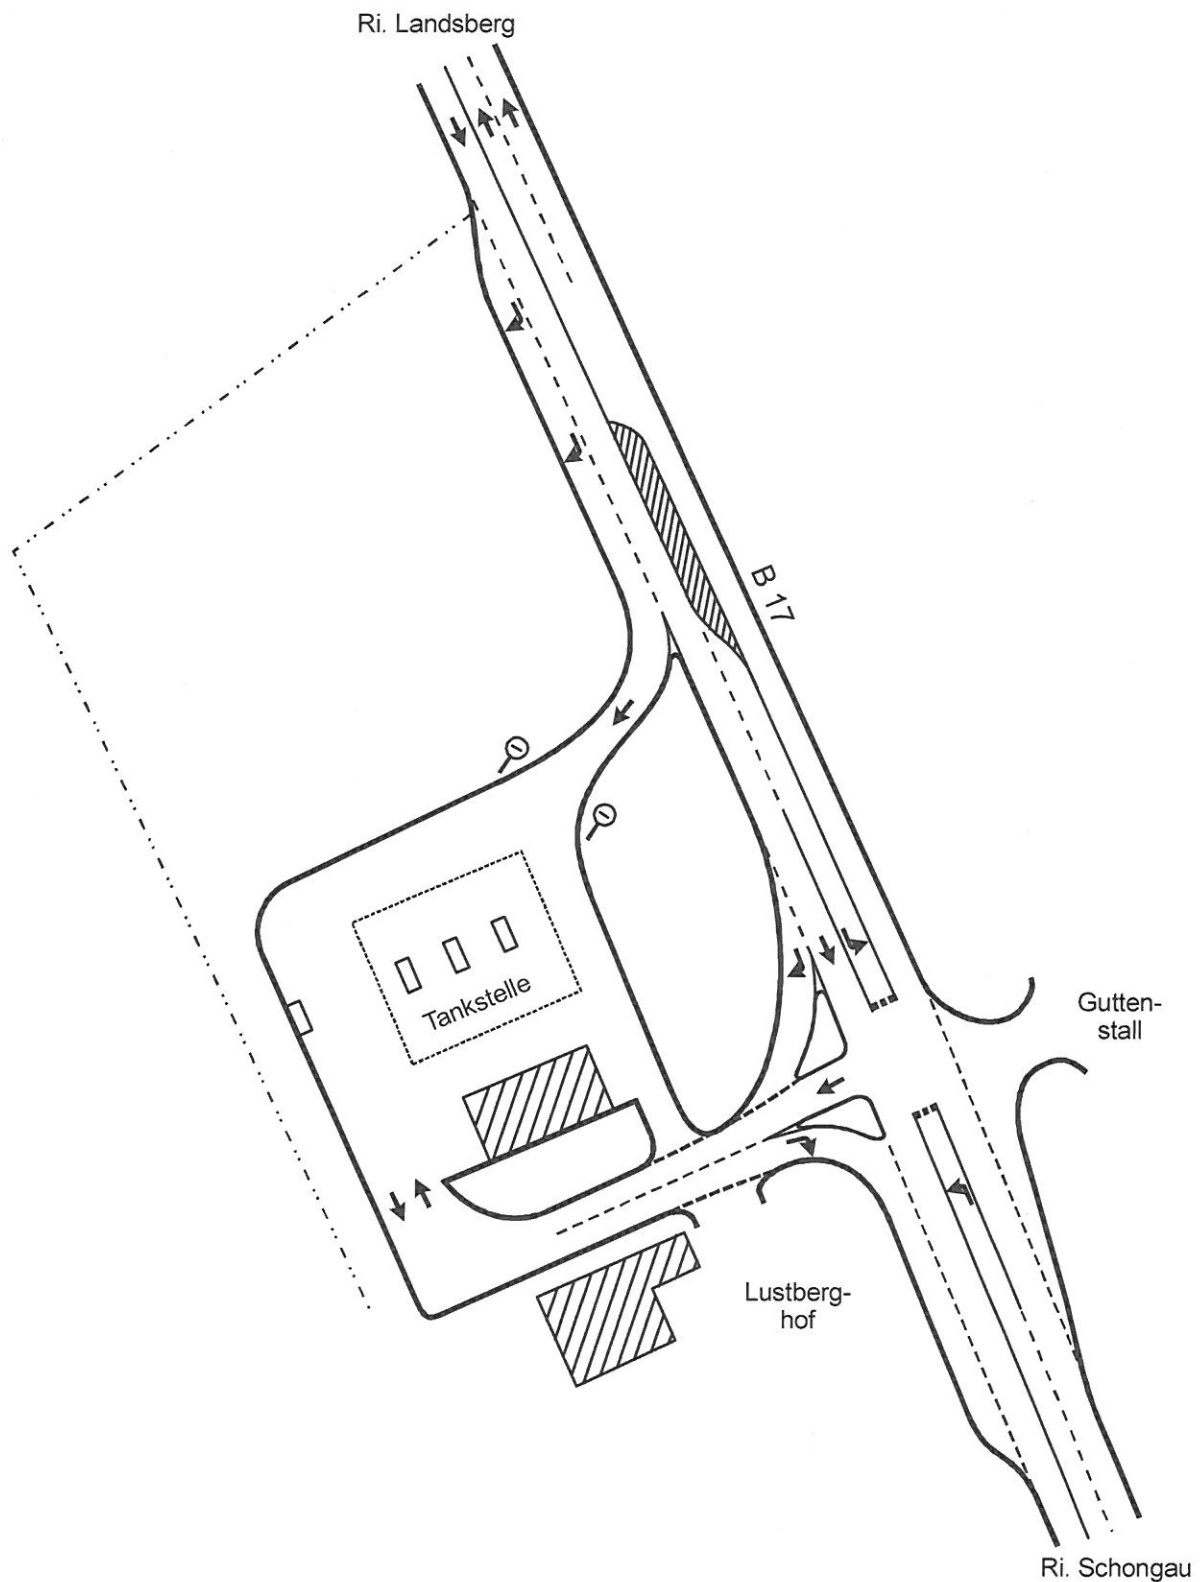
Lageplan der verkehrlichen Erschließung der geplanten Tankstellenanlage im Bereich Lustberg
